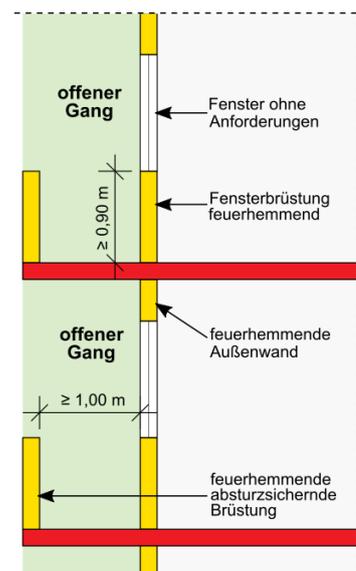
Prinzipskizze (Grundriss) offener Gang (Laubengang) mit einer Fluchtrichtung am Beispiel der Gebäudeklasse 5
